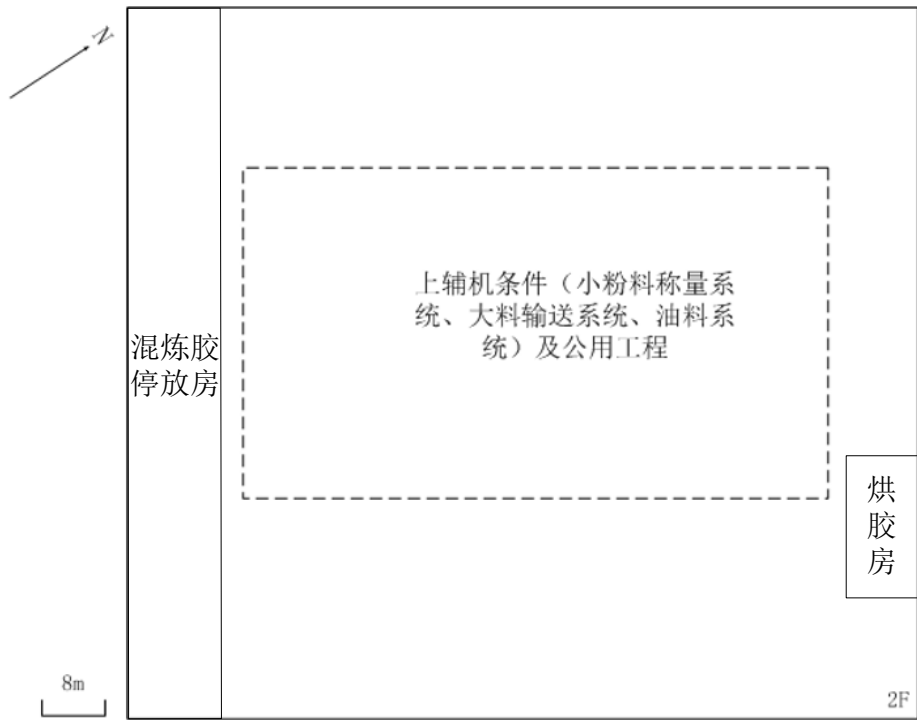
项目炼胶车间 2F 平面布置 (变动后)
